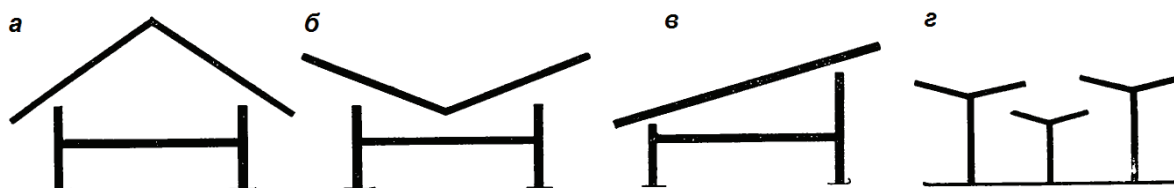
Покрытия зданий во влажном жарком климате:
